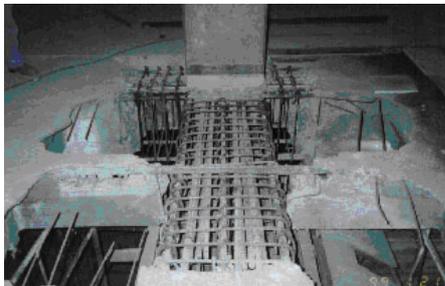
Pelapisan (*jacketing*) kolom-kolom beton bertulang eksisting menggunakan selimut beton bertulang baru (sumber: NRC 1995).
